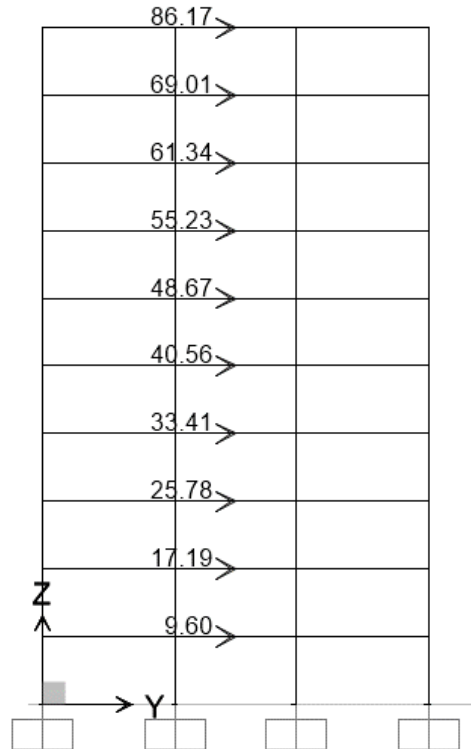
Aplicación de las cargas laterales en los centros de masa (dirección Y)
